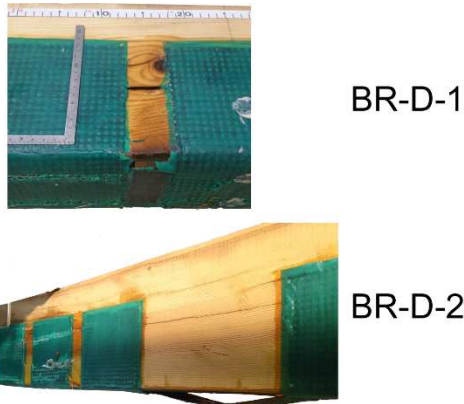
Imágenes de las roturas de las vigas con refuerzo trenzado de gran escuadría (BR). Arriba: BR-D-1. Abajo: BR-D-2. Casa comercial: DRIZORO®.
